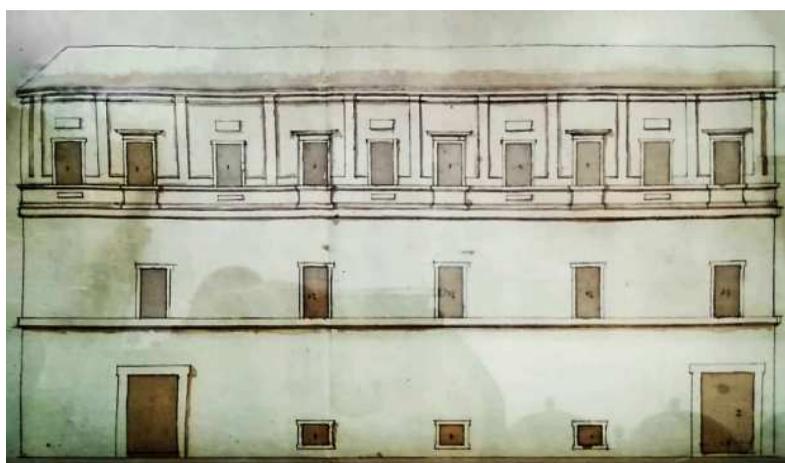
Alzado de la fachada a la actual calle de Garcilaso de la Vega.
